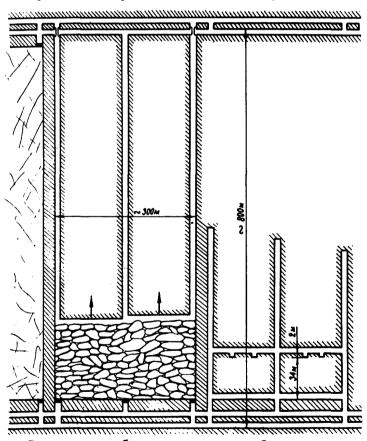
Система разработки длинными столбами с управлением кровли полным обрушением
